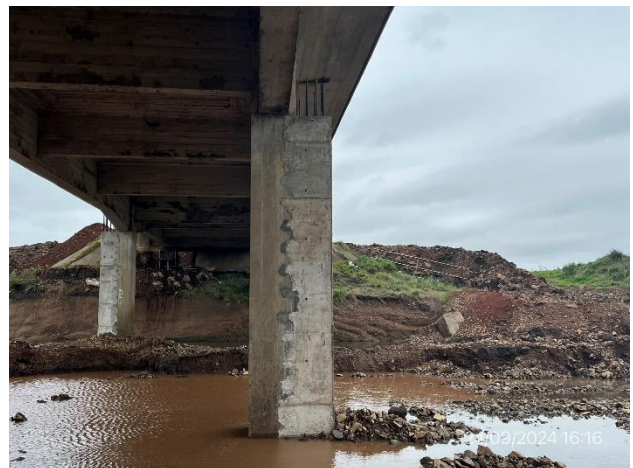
, P01. Recrecido de pilares en ejecución
